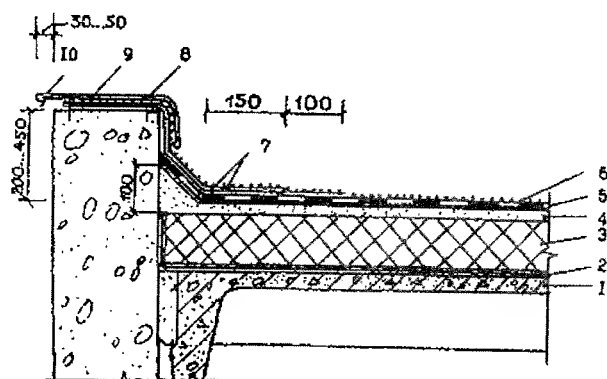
Примыкание кровли к парапету высотой до 450 мм
